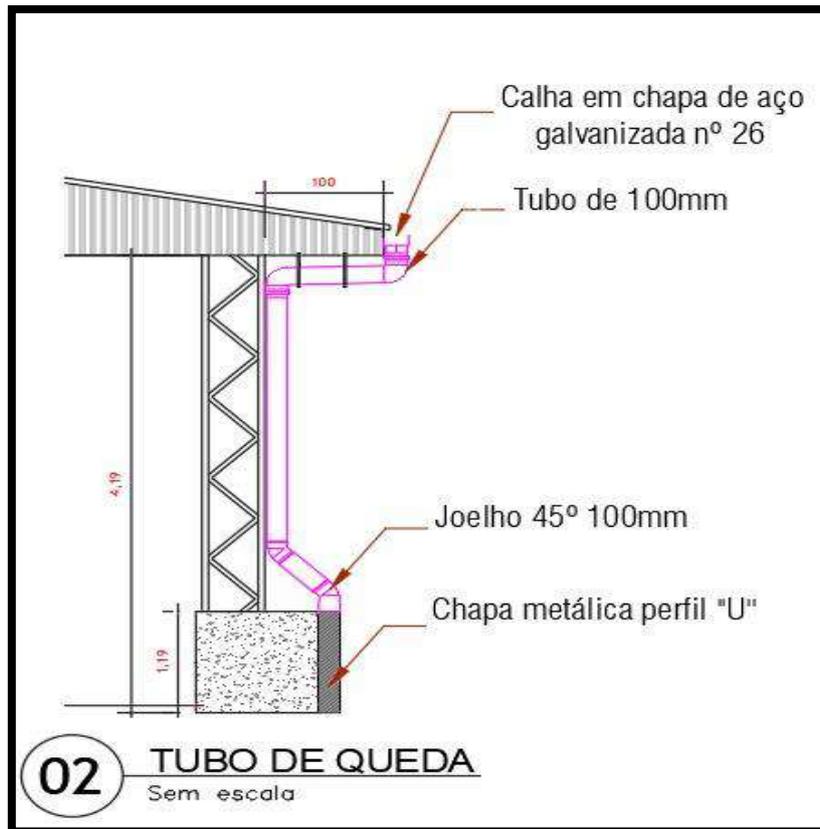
Tubulação de PVC 100mm a Ser instalada
